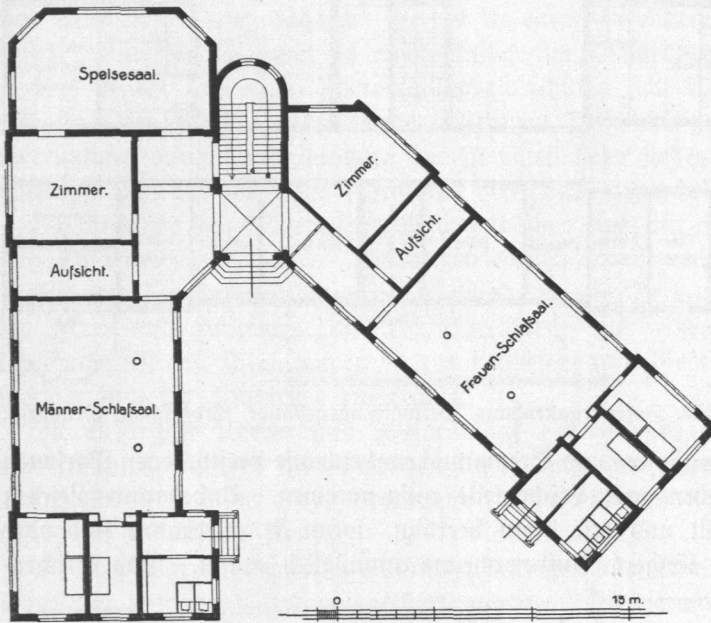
Hafenkrankehaus, Beobachtungshaus, Erdgeschoss, Grundriß.
